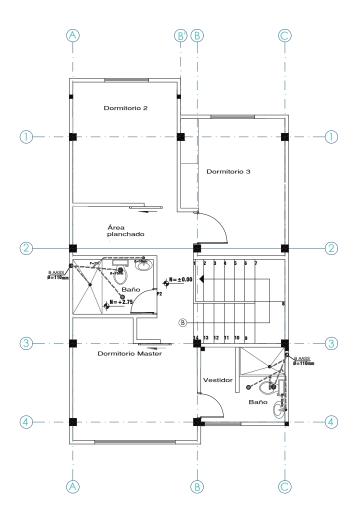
Instalaciones Sanitarias Planta baja propuesta Nota: Elaborado por el autor
